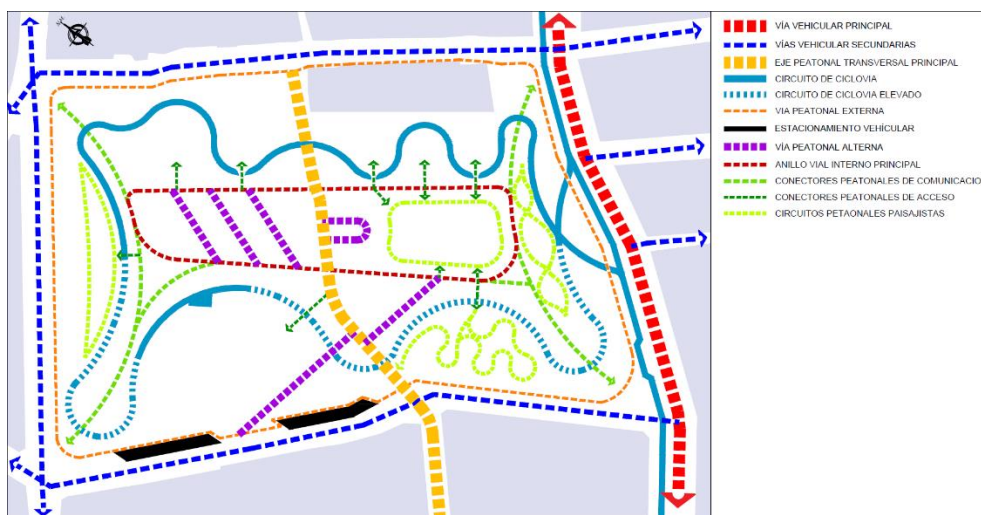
Sistema Vial de la Propuesta Arquitectónica
